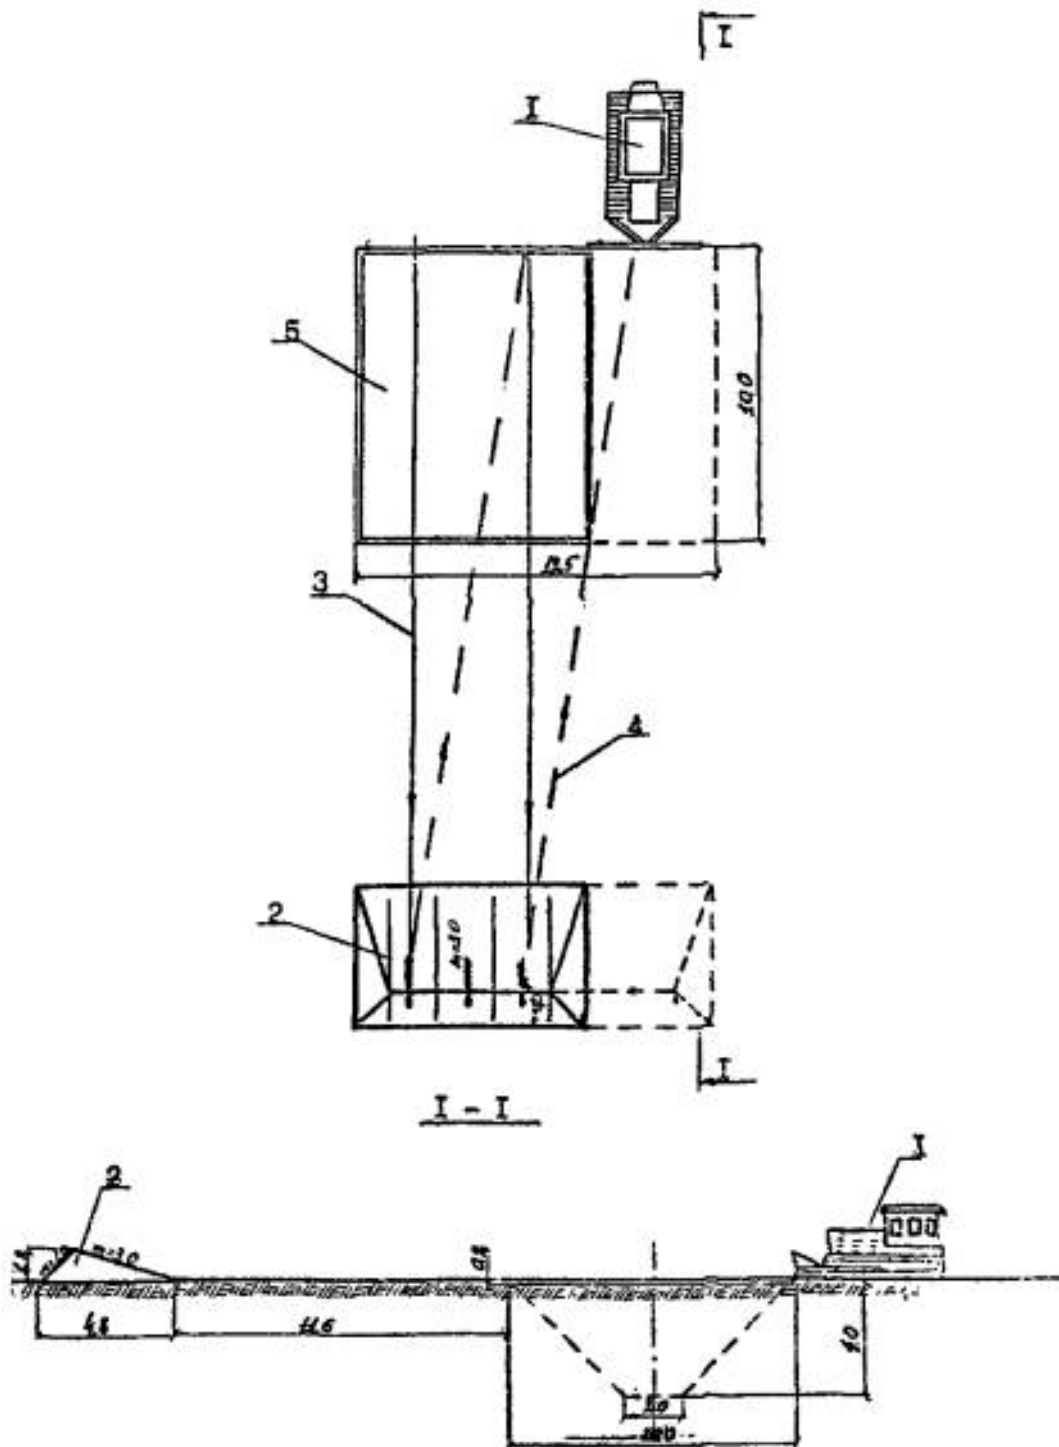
Схема производства работ при срезке грунта растительного слоя 1 - бульдозер; 2 - кавальер растительного грунта; 3 - рабочие ходы бульдозера; 4 - холостые ходы бульдозера; 5 - поверхность котлована
